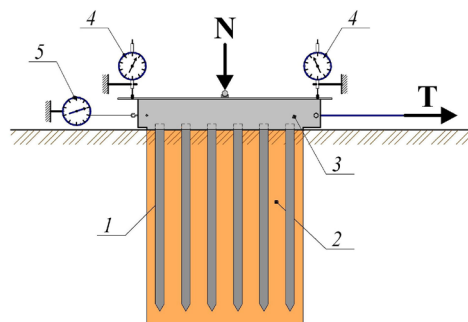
Расчетная схема свайно-грунтового фундамента: 1 – призматические сваи; 2 – уплотненный околосвайный грунт; 3 – ростверк; 4 – приборы для измерения горизонтальных и вертикальных перемещений фундамента
